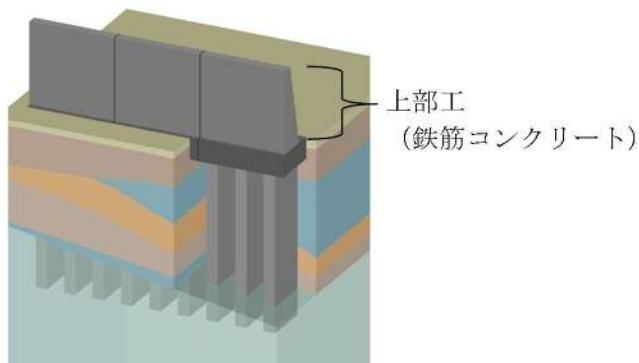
鉄筋コンクリート防潮壁の上部工
